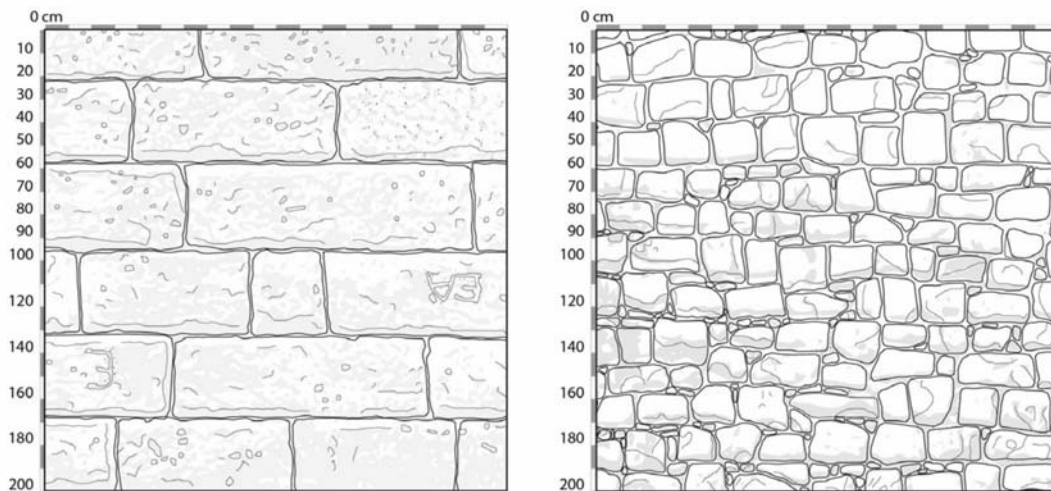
Studio dell'apparecchio murario del prospetto sud di Porta rosa, primo e secondo livello.
